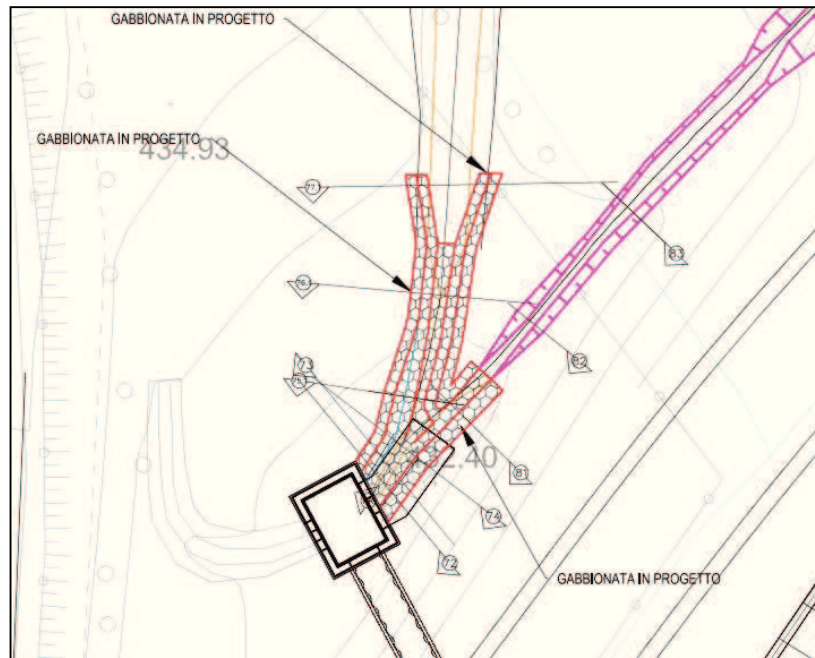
Stralcio planimetria interventi in progetto rio e fosso 1.
